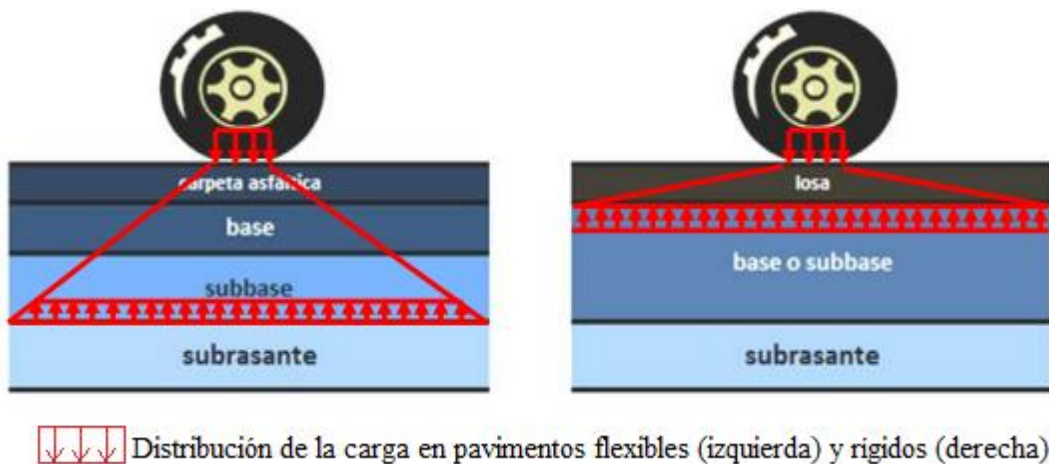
Comportamiento del pavimento frente a cargas de tránsito
